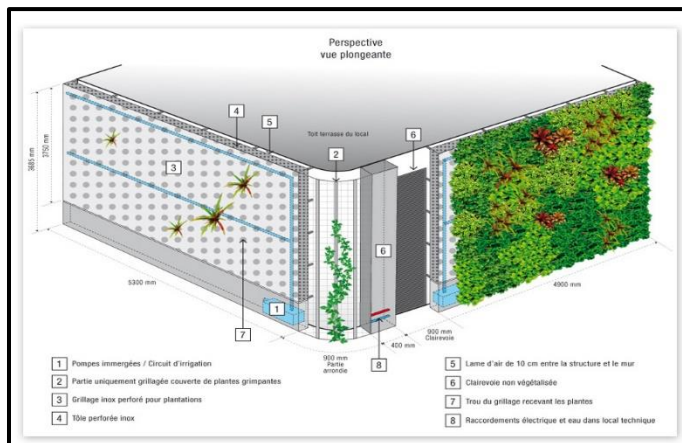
Plans et mise en situation de l'habillage d'un local technique a Bagnolot (Source: <https://www.vegetalindoor.fr/>)
